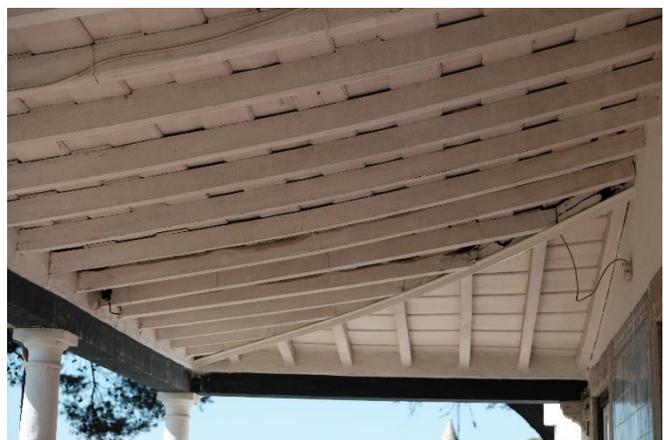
Vista geral da estrutura/tecto da varanda, onde se podem observar diversas deformações estruturais (PM, 15.10.2024).
